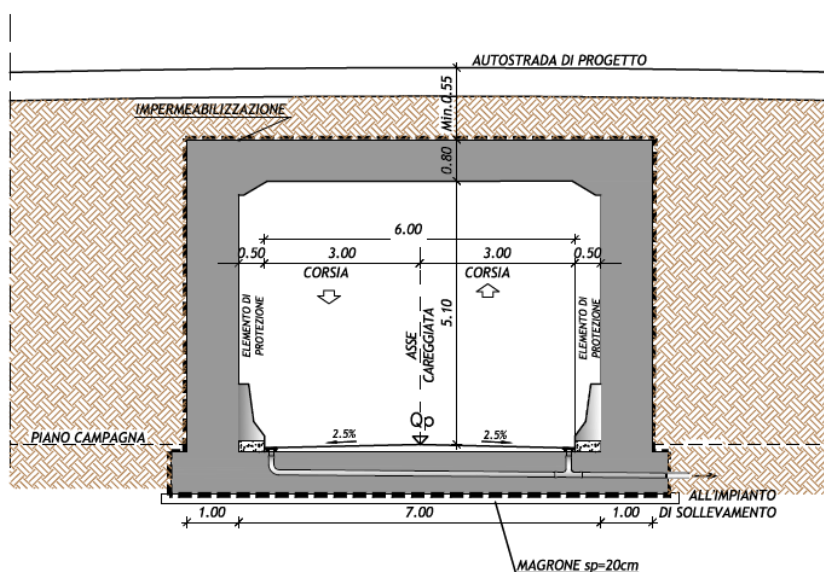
SEZIONE TIPO SCATOLARE CHIUSO
